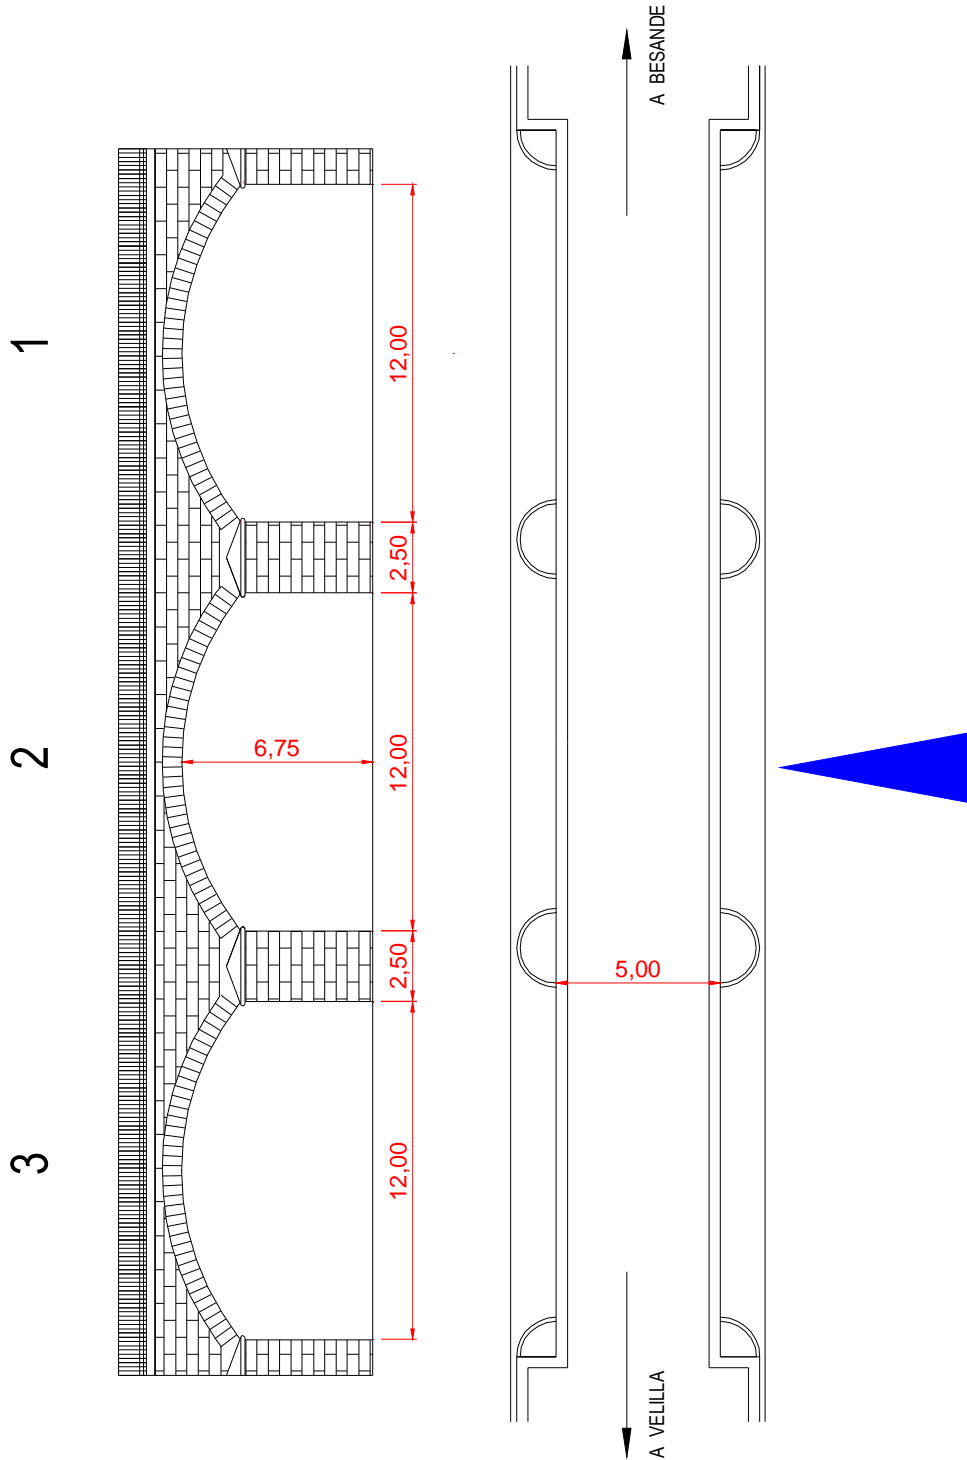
Planta y alzado de aguas abajo del puente en Velilla del río Carrión
